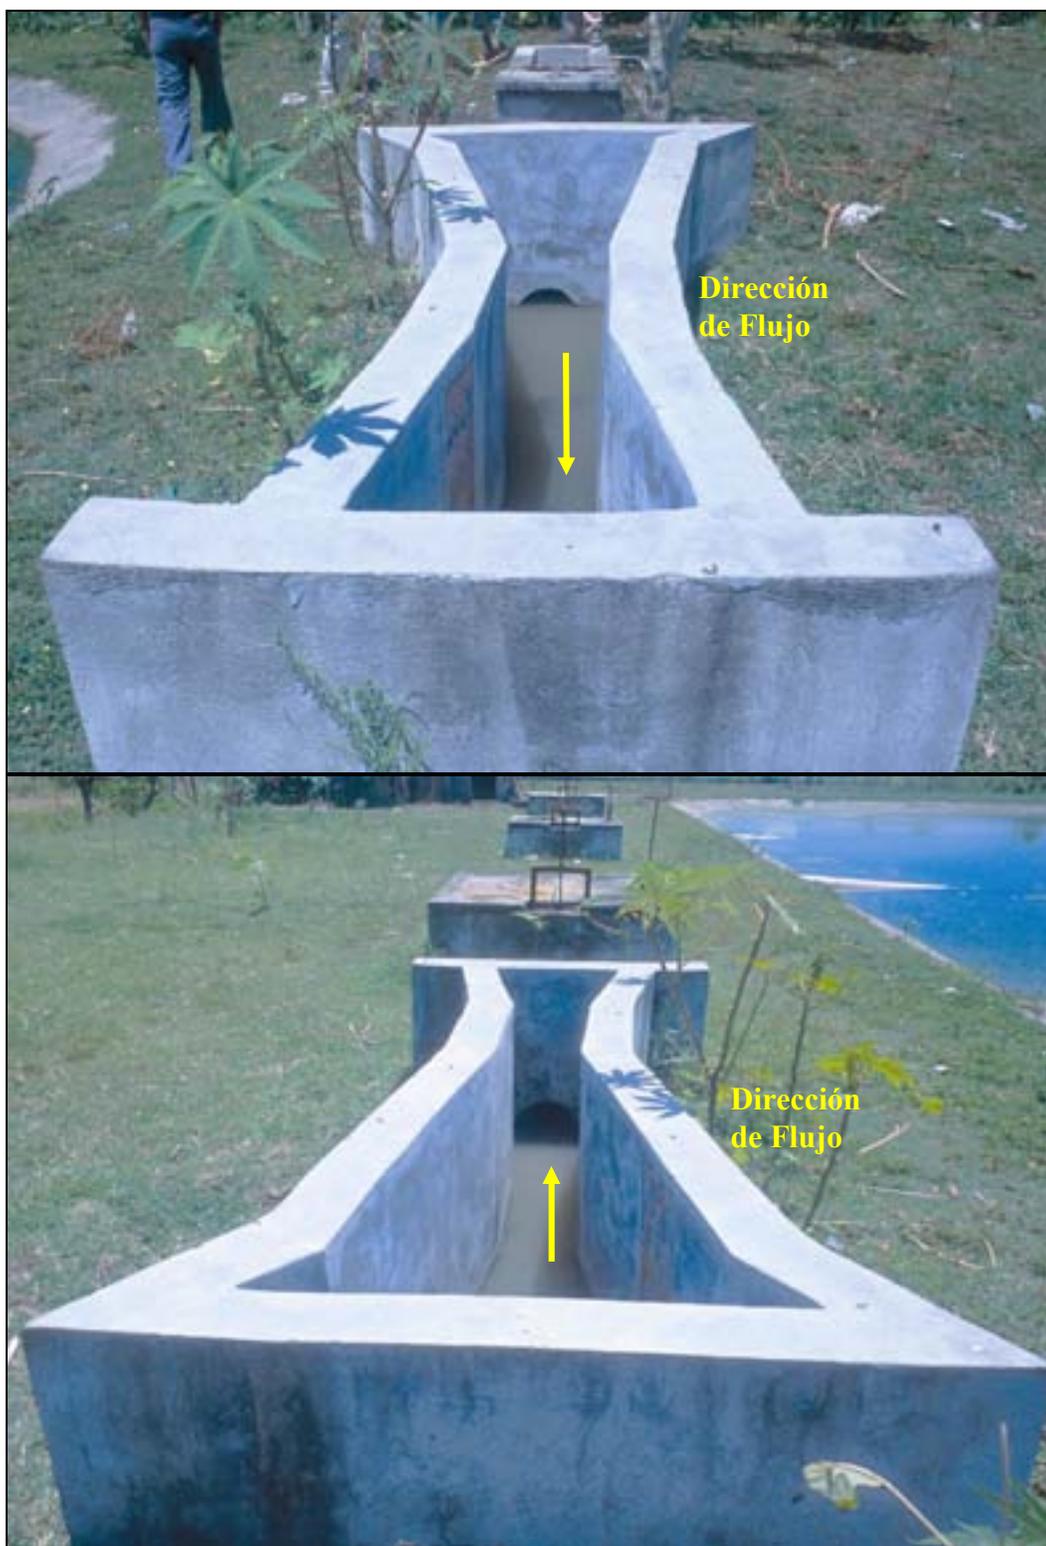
Un ejemplo de una canaleta Parshall prefabricada instalada en un sistema de lagunas. El diseñador siempre debe requerir canaletas Parshall prefabricadas en el diseño y nunca canaletas Parshall hechas de concreto por los problemas de construcción y calibración como se muestran en las Fotos 3-12 y 3-13 adelante. (Masaya, Nicaragua)
